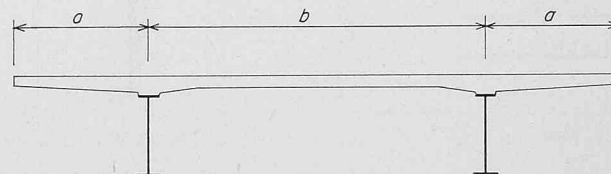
Ponts parallèles indépendants le long de l'autoroute du Léman, coupe schématique
